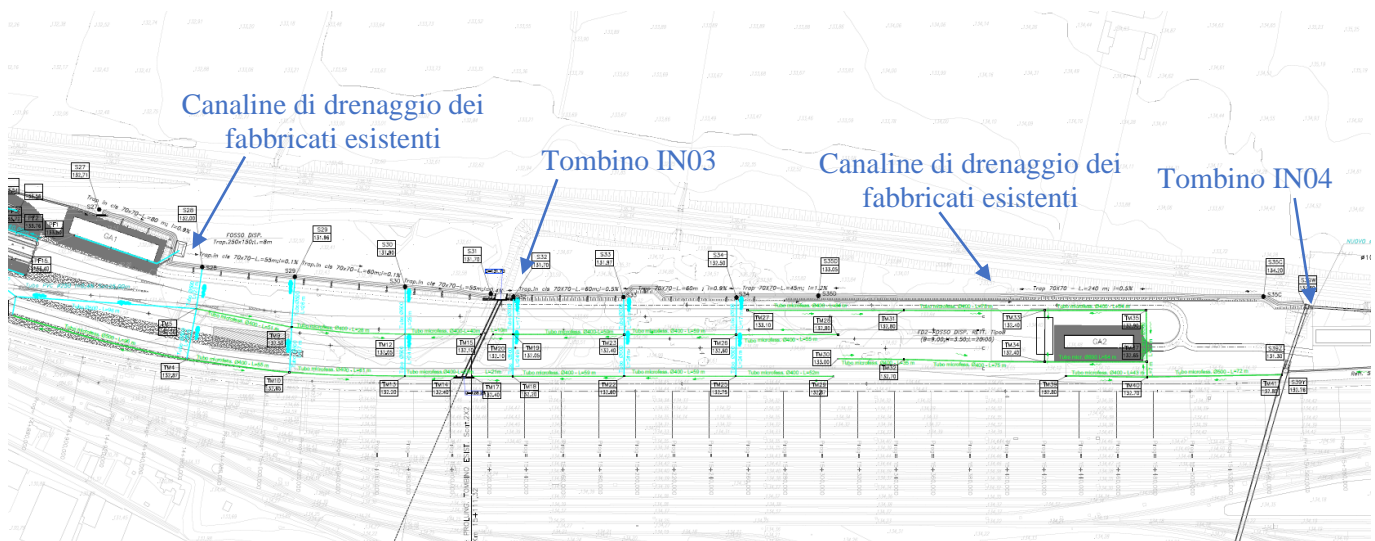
Sistema di drenaggio esistente Area Fabbricati – Fonte: IN01_0_1_C_ZZ_P8_RI_38_0_3_003_E: RI38 - Rilevato dal km 14+767,86 al km 15+829,97 – Planimetria di idraulica
